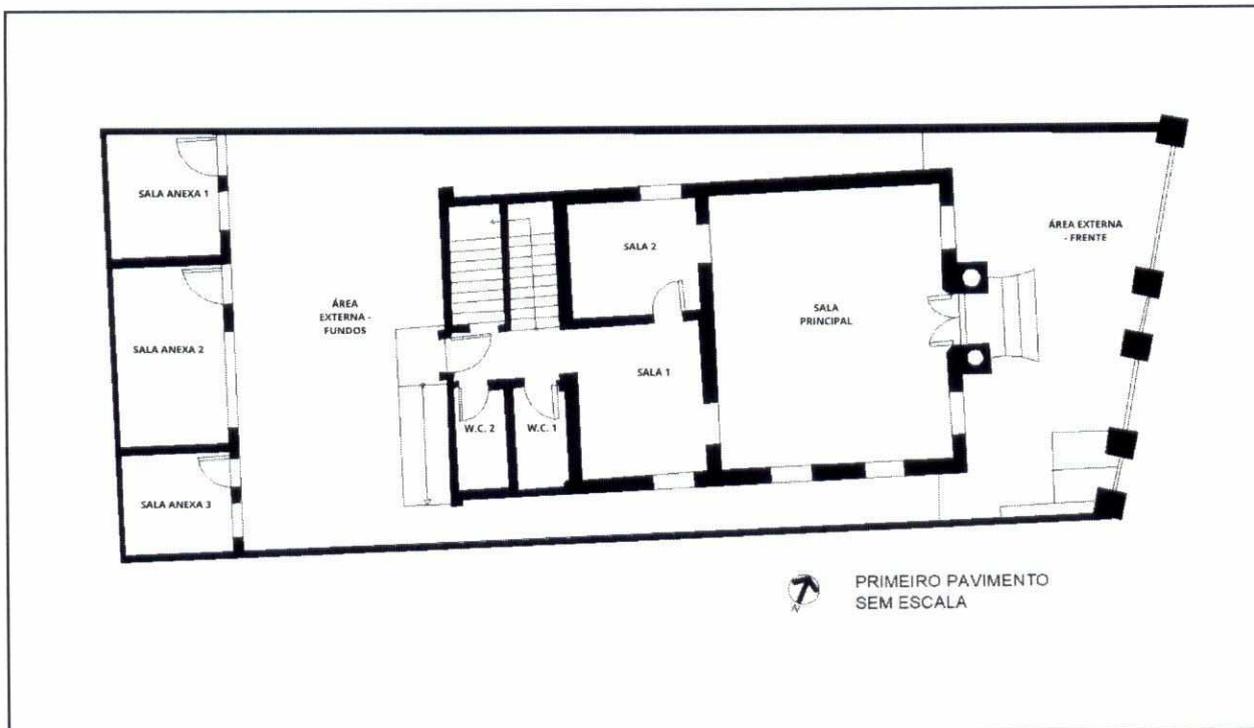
Planta esquemática do primeiro pavimento da Casa de Anita. Execução: Ana Clara Faria, 24/05/2024.
